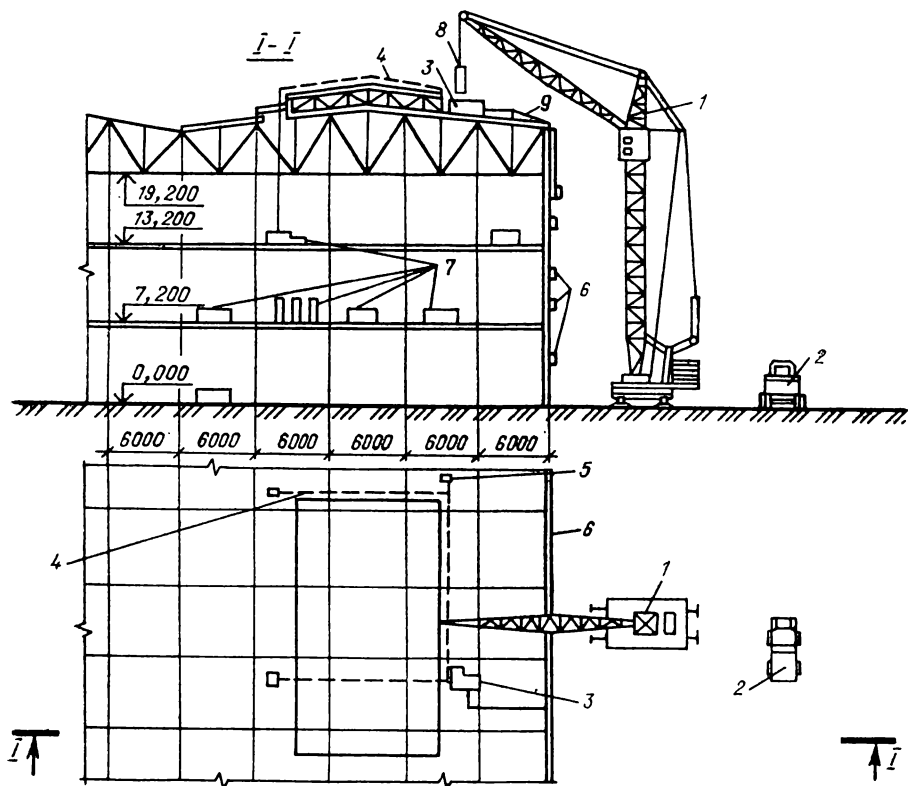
Схема подачи бетонной смеси при помощи башенного крана с пневмоустановкой, установленной на покрытии здания:
